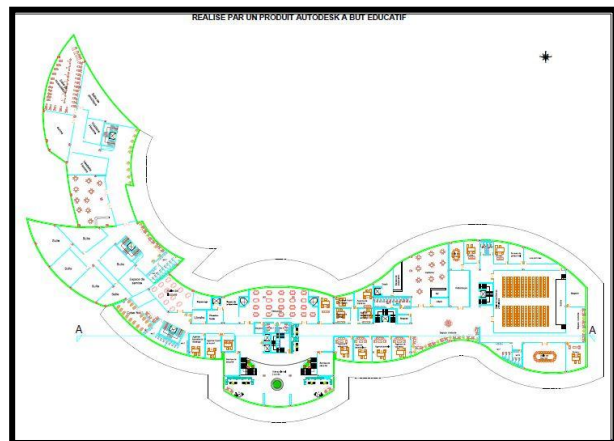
plan de rez-de-chaussée du projet. Source : Auteur du mémoire
